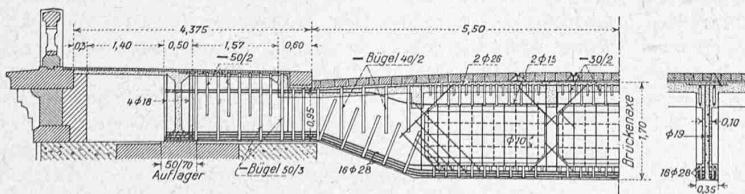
Fahrbahn-Querträger, Armierungsplan. Ansicht und Schnitt, 1:120.
